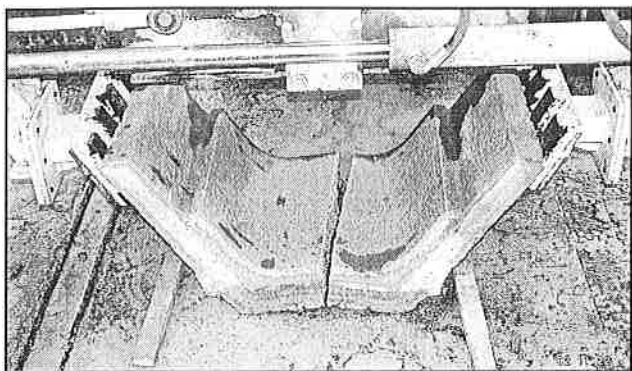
ábra. Néhány napos mederburkoló betonelemek a gyártó téren
